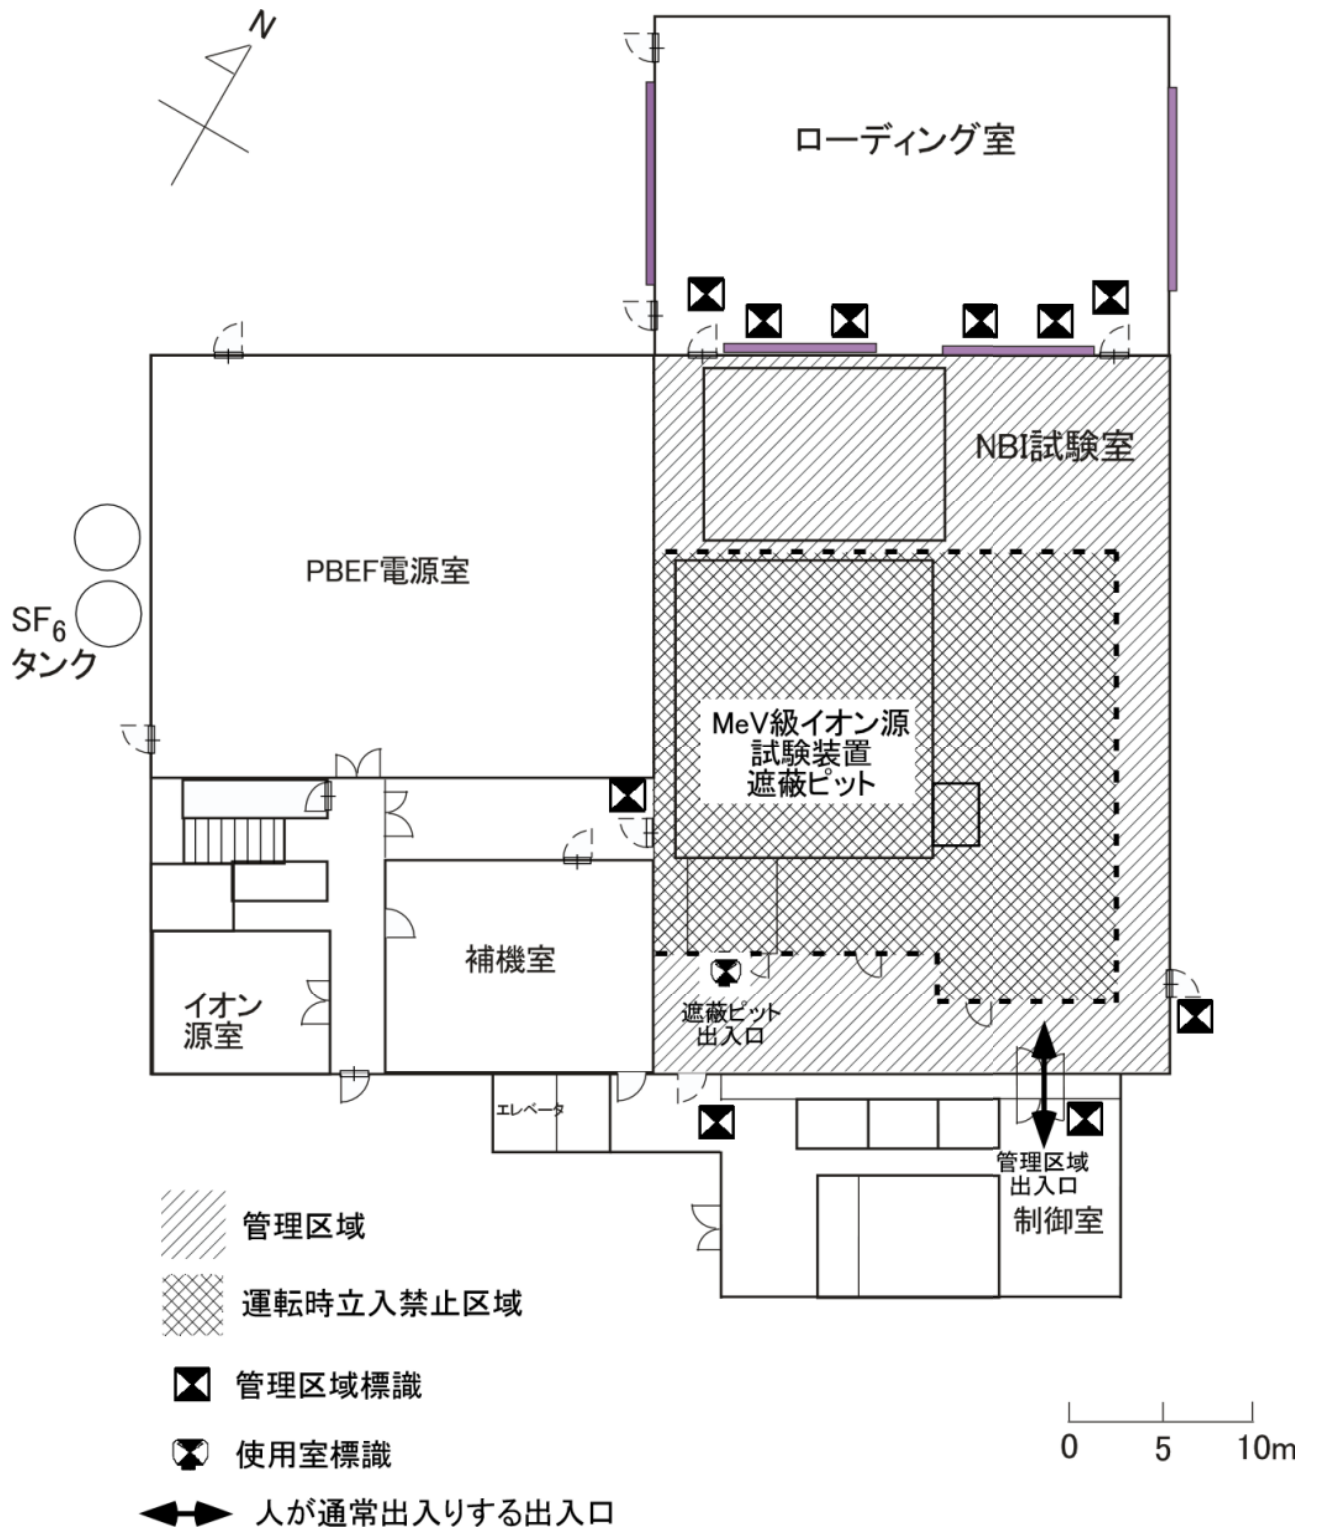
JT-60 実験準備棟 1 階平面図 (管理区域境界、標識)
